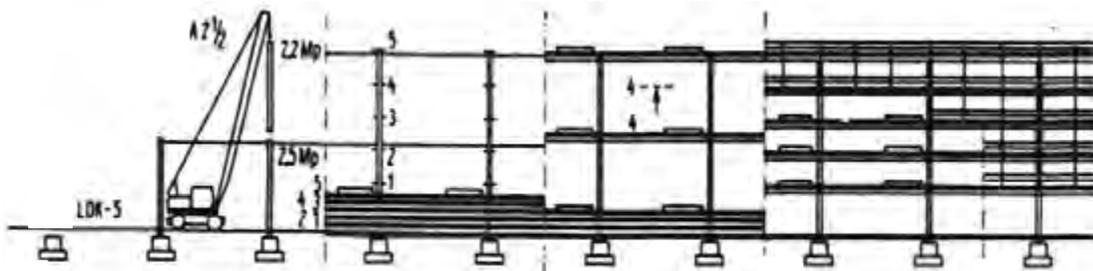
Монтаж колонн и перекрытий методом подъема этажей
